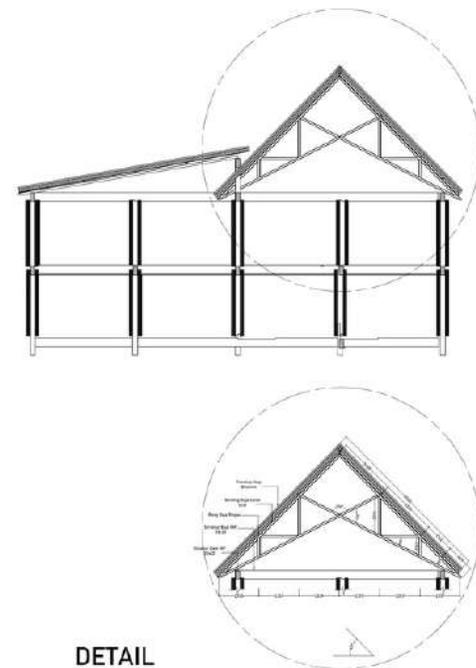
Potongan Bangunan Pendukung
